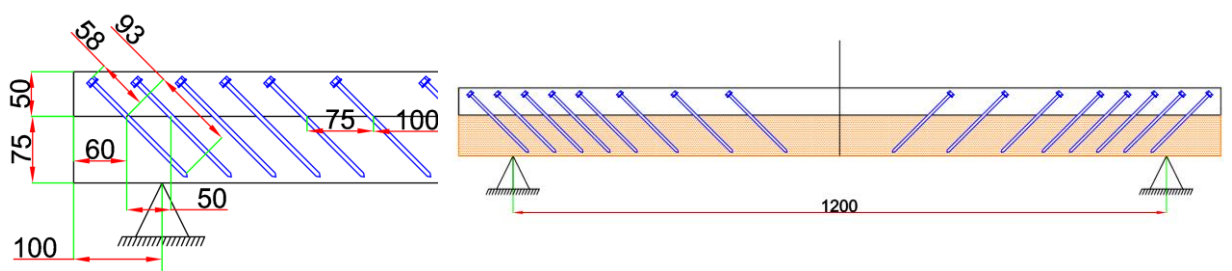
Conception et configurations des poutres mixtes bois-béton testées.
